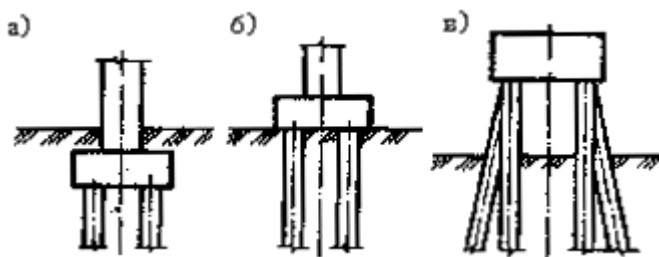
Пальові фундаменти з низьким і високим ростверком: а, б - фундамент палі з низьким ростверком; в - фундамент палі з високим ростверком.
